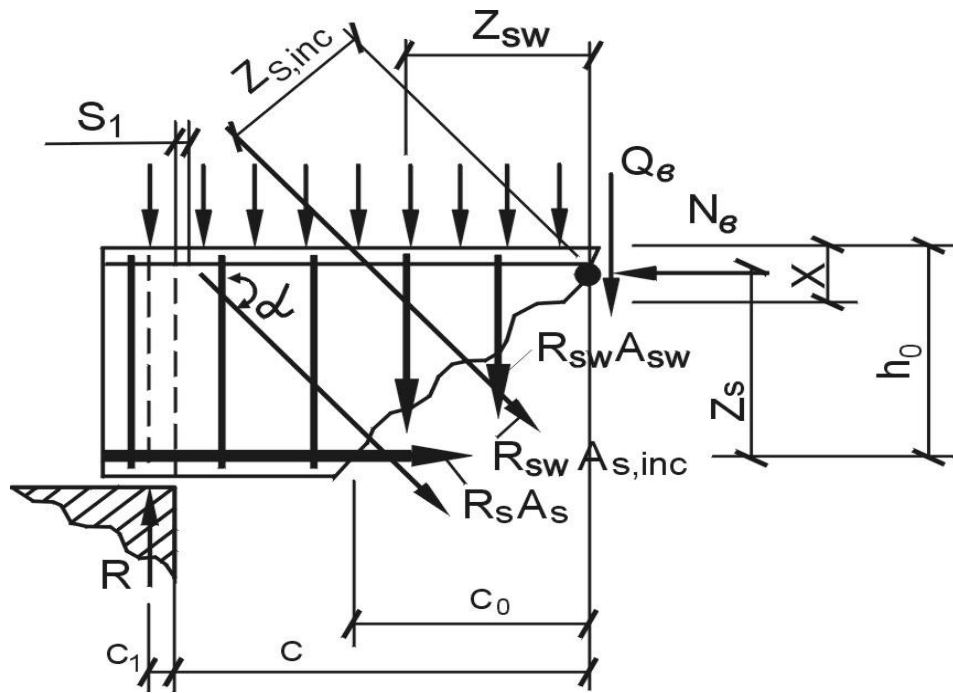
Распределение усилий в наклонном сечении изгибаемой конструкции.
